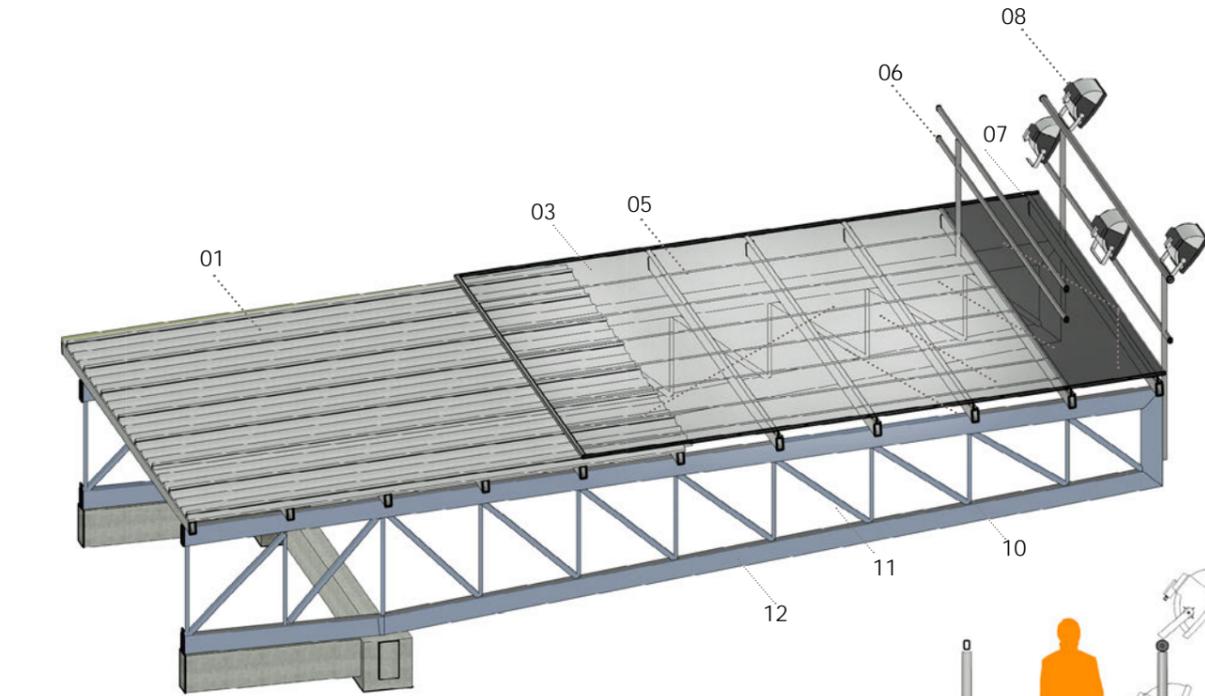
Detalle 3D de cubierta en voladizo. Fuente: Elaboración propia.
